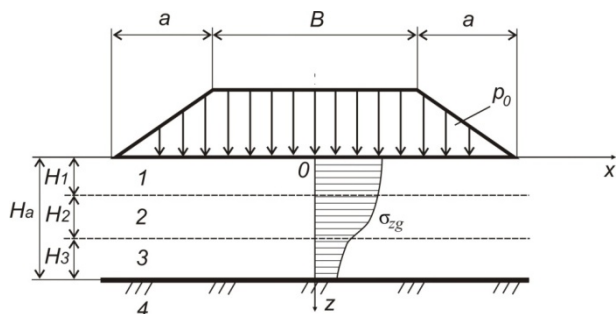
Расчетная схема слабого основания насыпи для расчета осадки и консолидации
